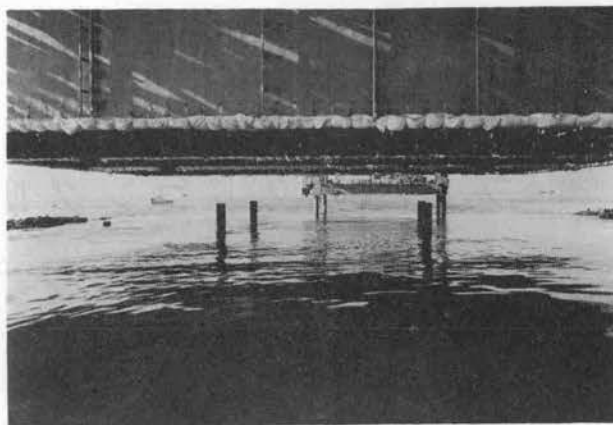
4A ケーソン沈設直前の刃口部と鋼管の状況
